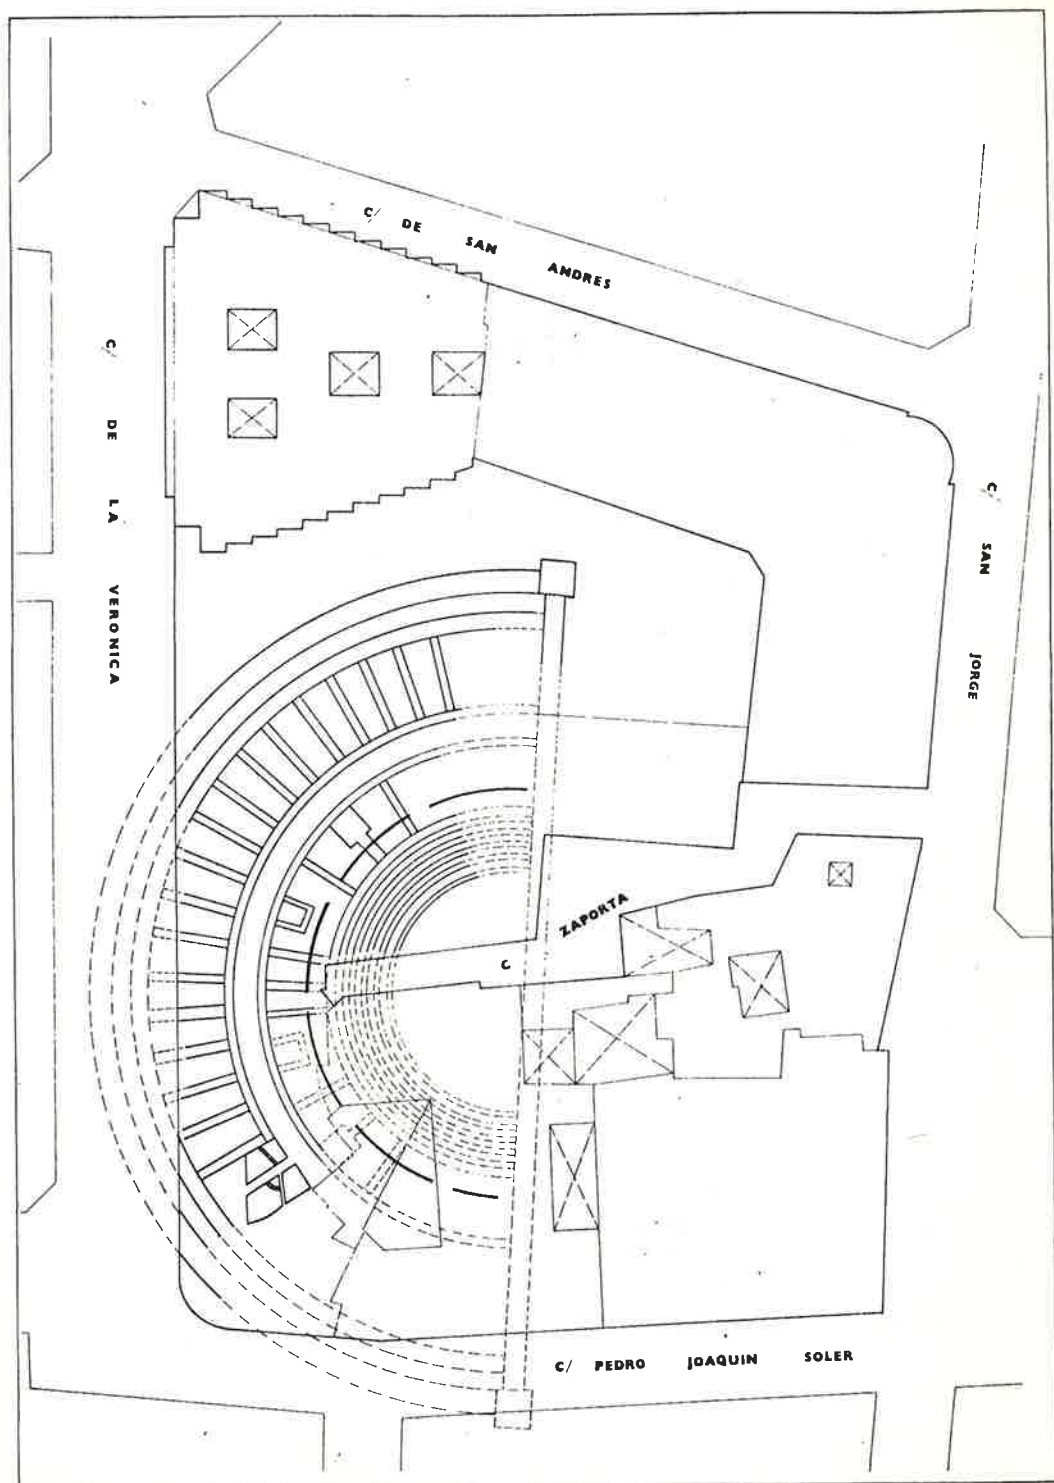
Teatro Planta general (seg. A. Beltrán). Las líneas gruesas corresponden a las estructuras halladas.
